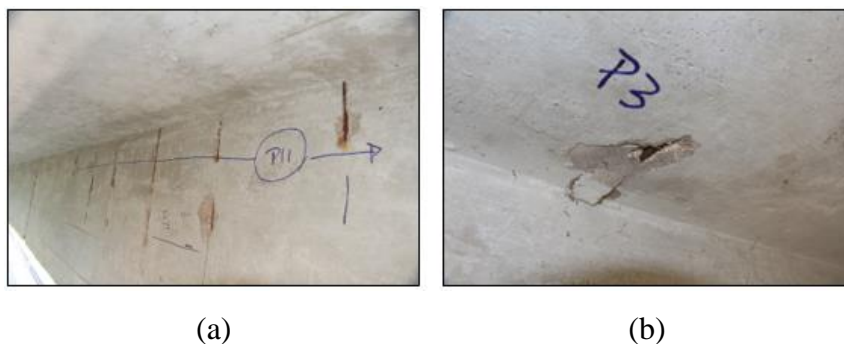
Corrosão e delaminação parcial na face lateral da viga (a) e na face inferior da laje (b)
